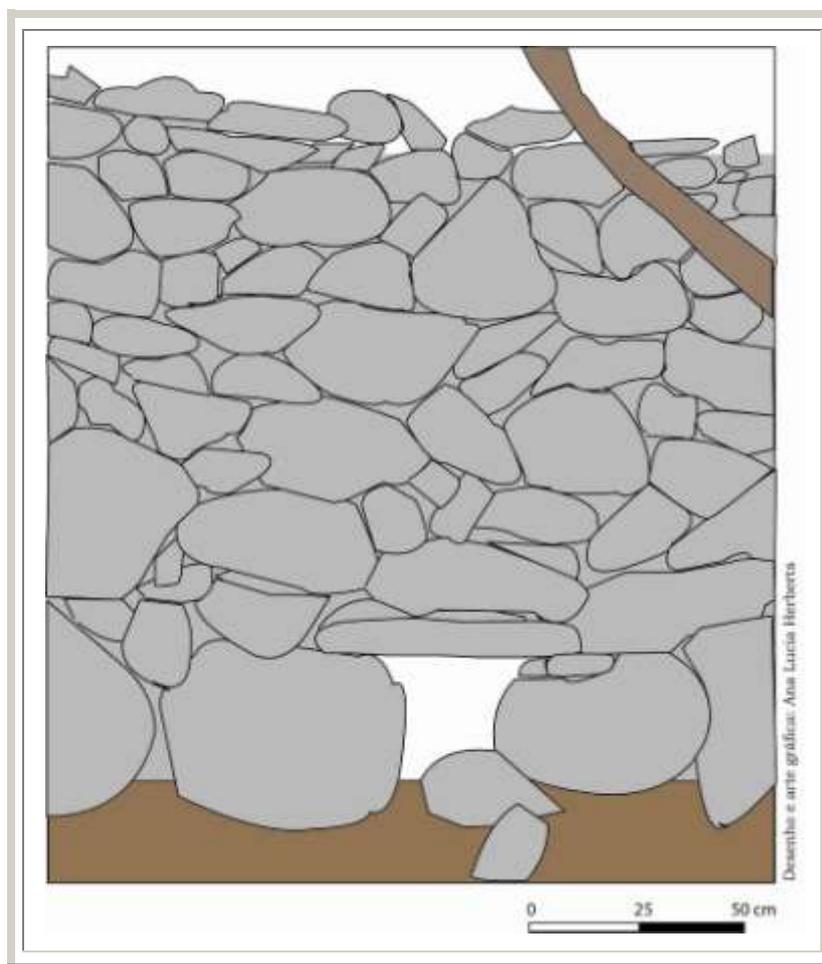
Desenho de um dreno situado no trecho A (pt-136), detalhando a sua construção na taipa
